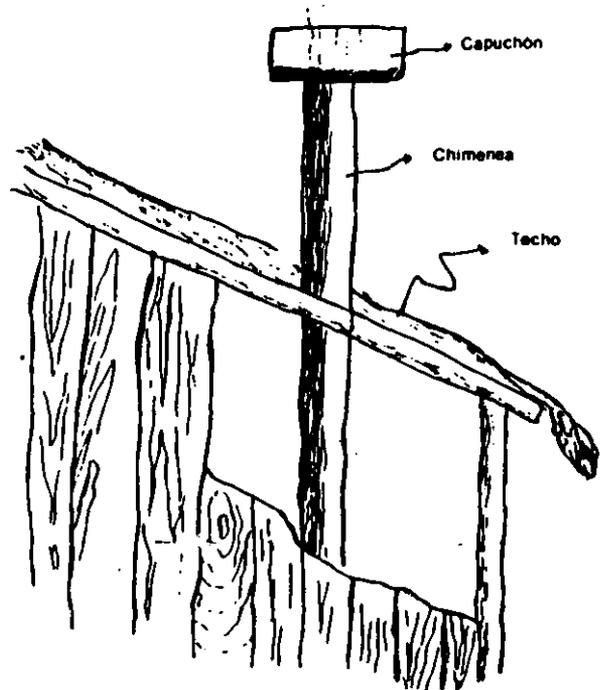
Detalle de la chimenea que sale del techo de la vivienda.
